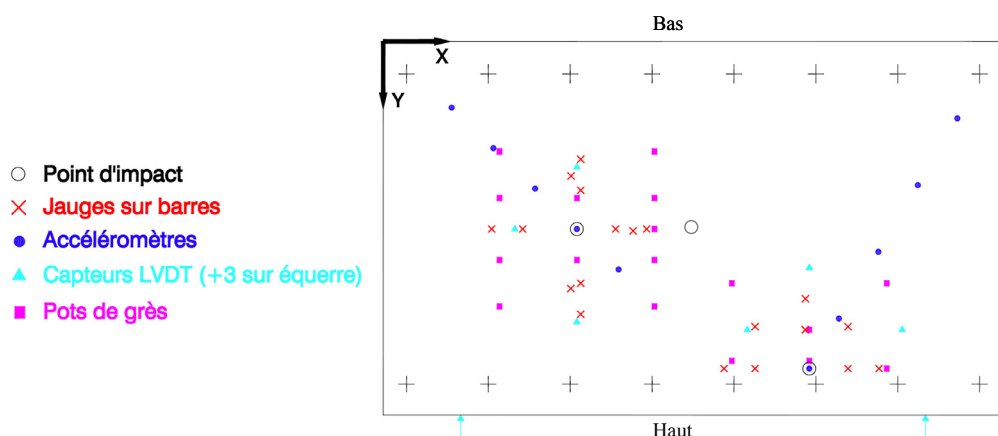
instrumentation pour les essais sur dalle inclinée
